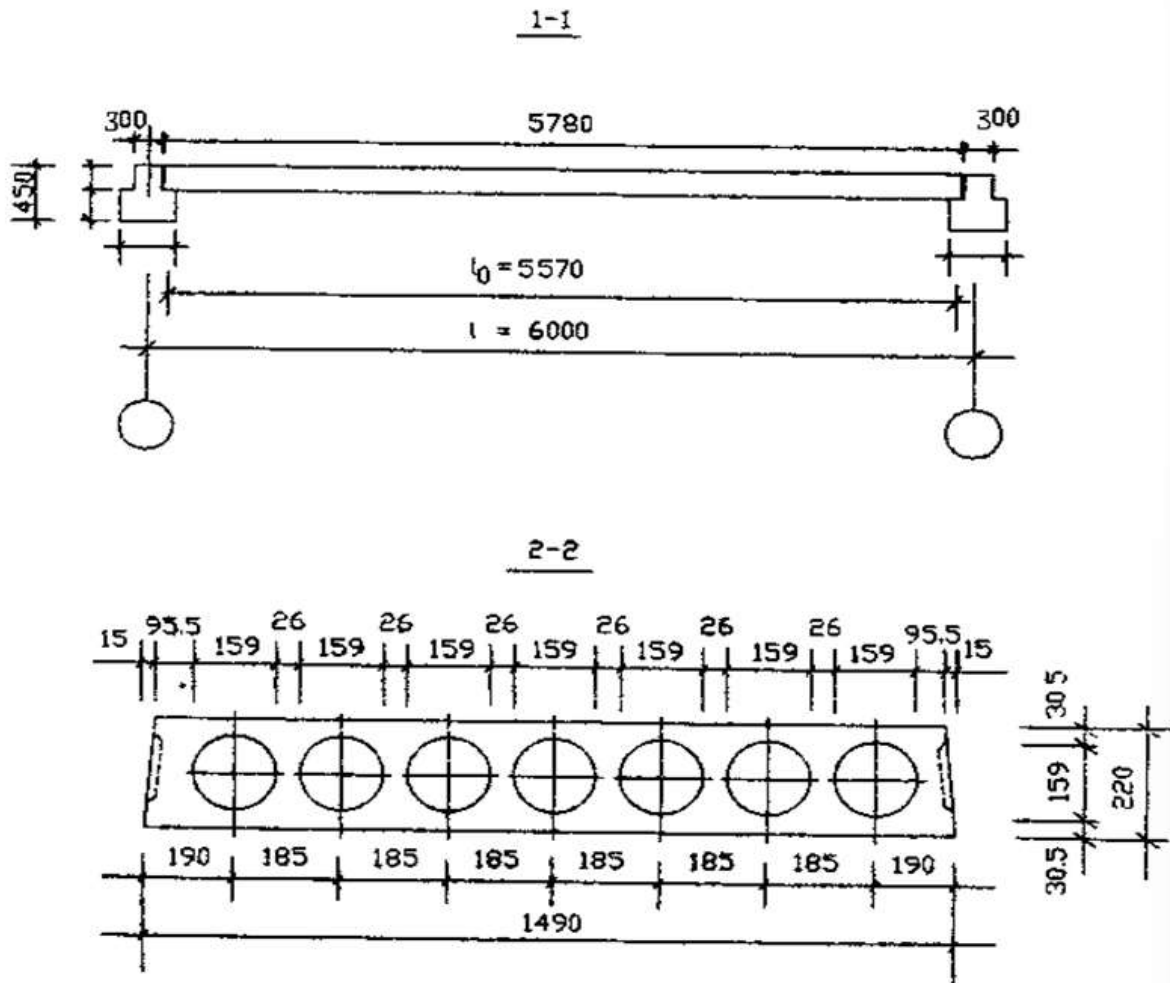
Прийнята багатопустотна плита перекриття
